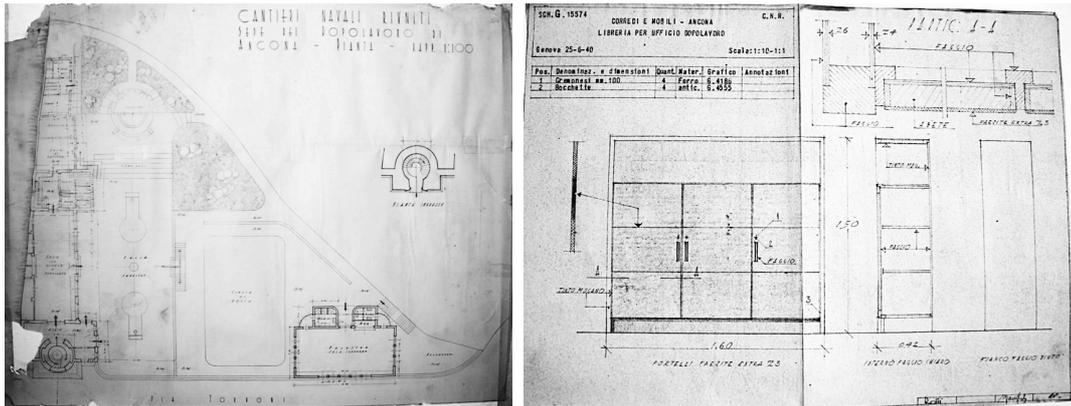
A sinistra: planimetria “Cantieri Navali Riuniti – Sede del Dopolavoro di Ancona”, s.d.; A destra: C.N.R., “corredi e mobili Ancona, Libreria per ufficio Dopolavoro” Genova 25-5-40. ASAn, Fondo Luchetti
